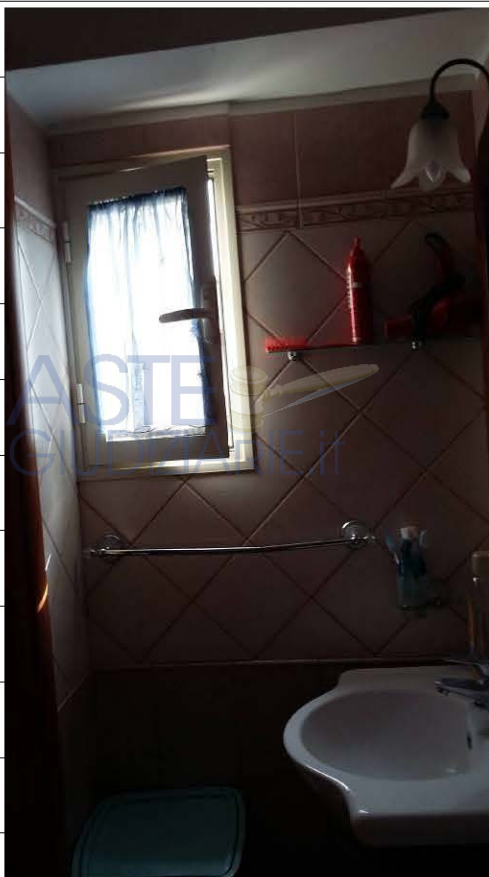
12 - LOTTO A_WC2 (Piano terzo)
